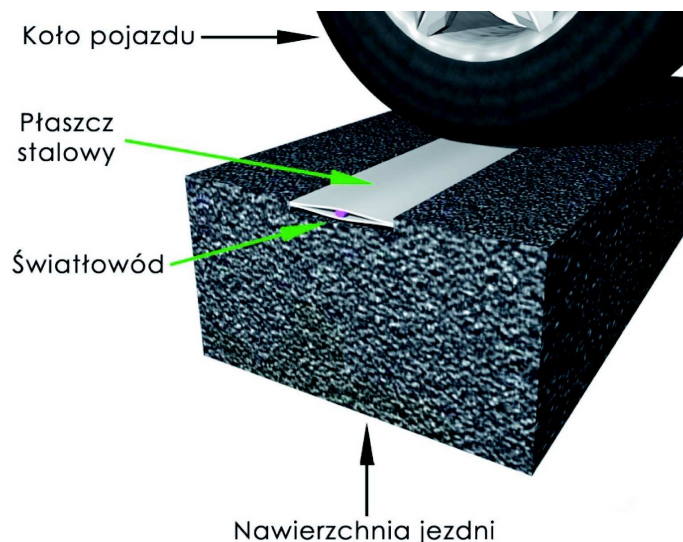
Przekrój poprzeczny profilu nawierzchni jezdni z zamontowanym czujnikiem płytowym (opracowanie własne)
